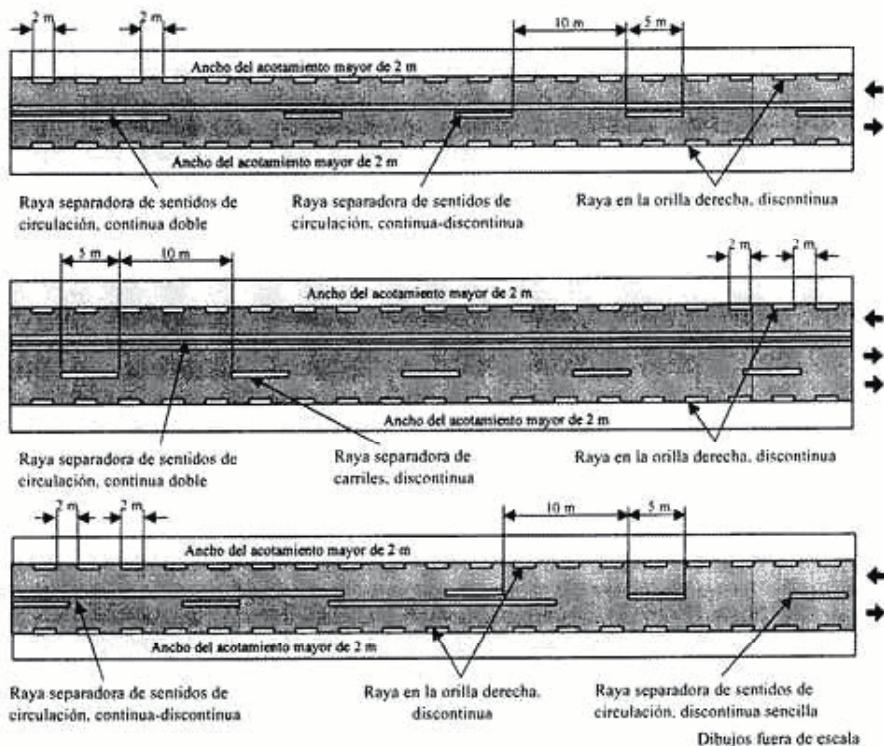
Marcas en el pavimento en carreteras con ancho de arroyo vial mayor de 6,5 m
